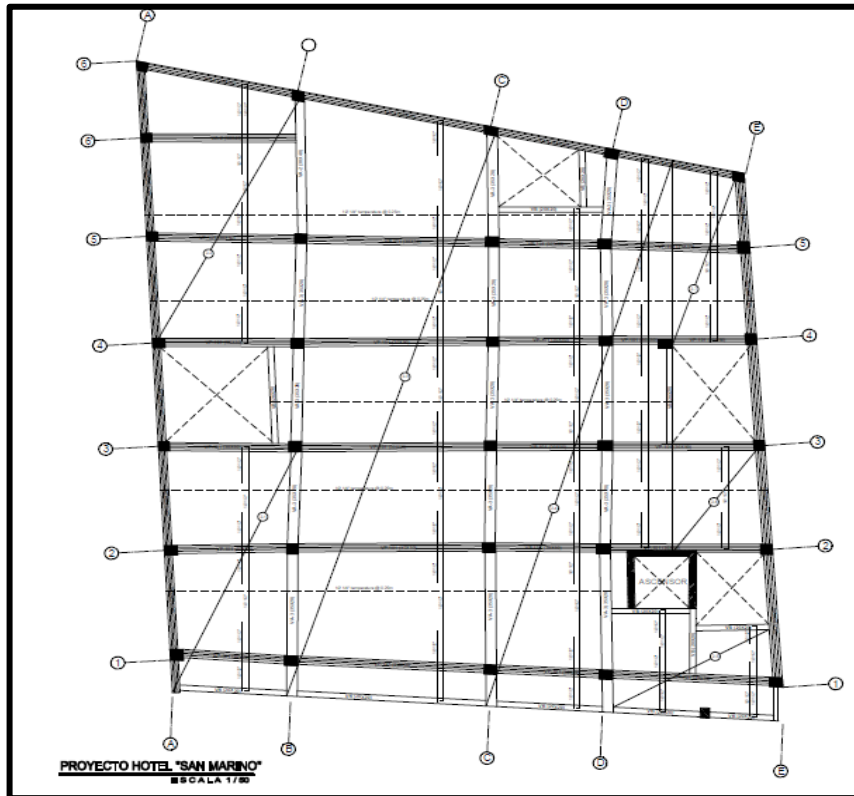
VISTA EN PLANTA – 3°,4°,5° 6°,7° NIVEL
